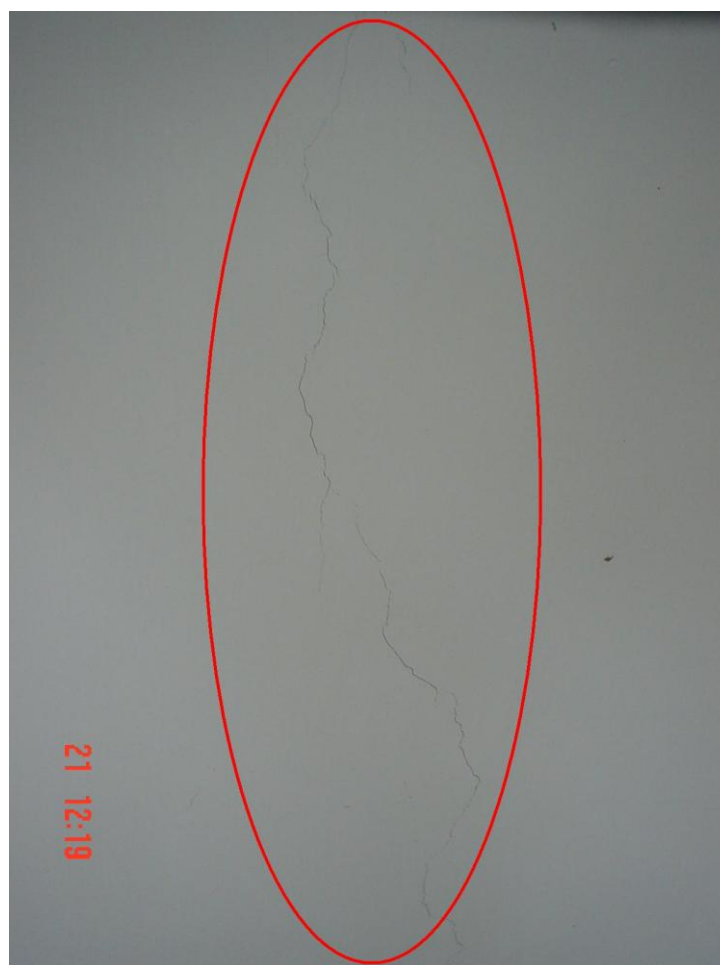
DETERIORO Y FISURAS EN PARED LATERAL IZQUIERDA
